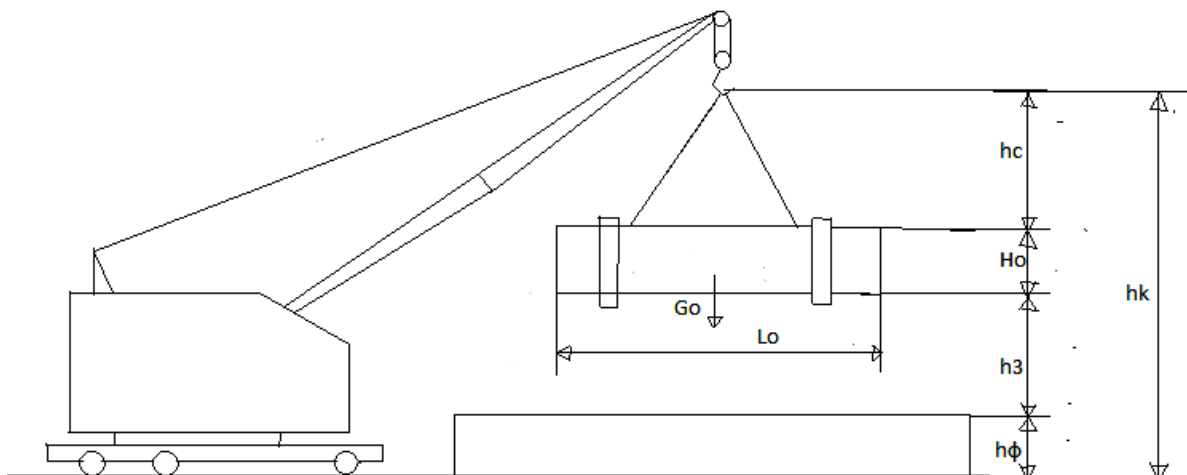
Схема подъема сушильного барабана и установки его на фундамент
